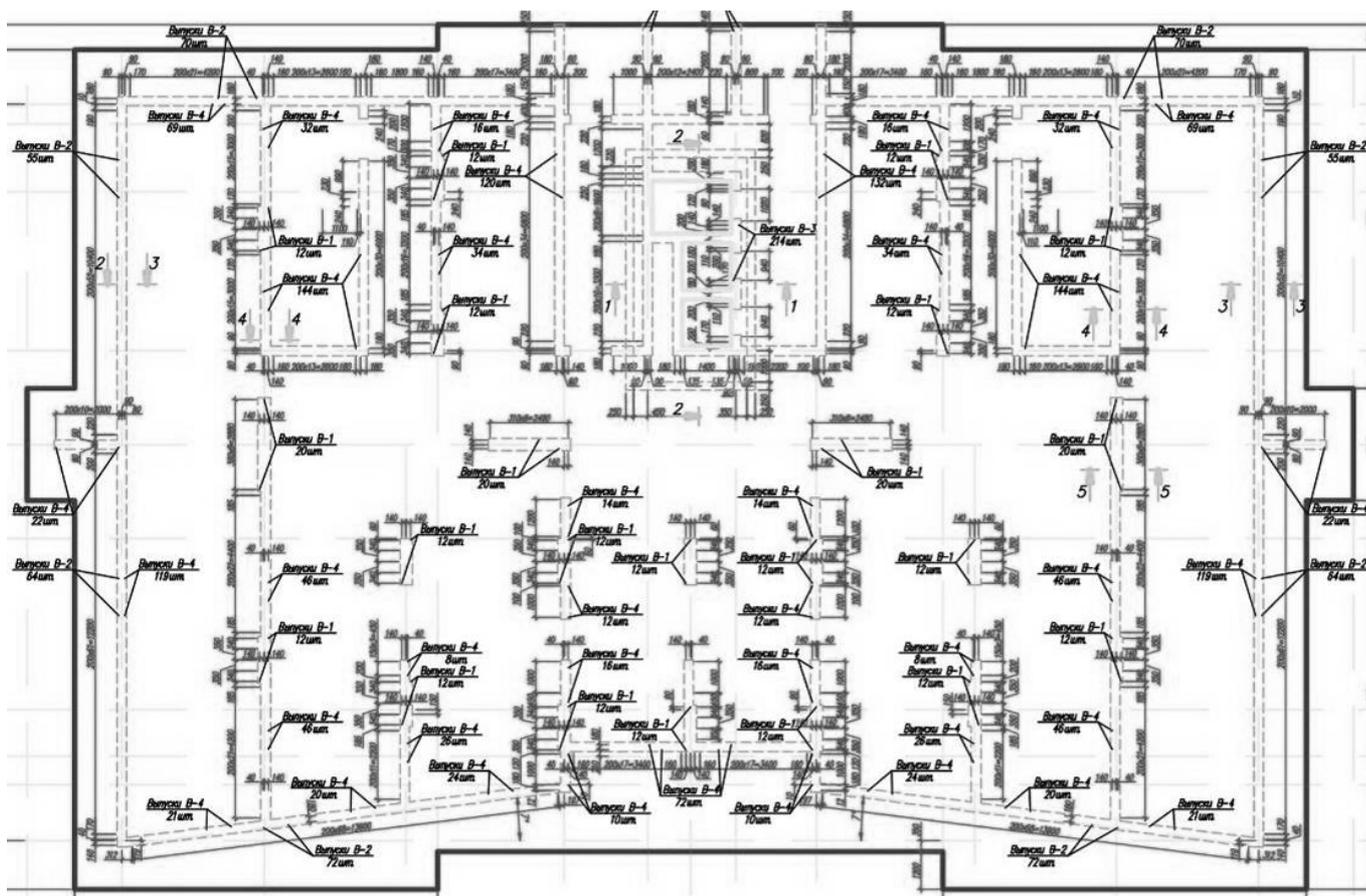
Опалубочный план плитного ростверка комбинированного свайно-плитного фундамента (КСПФ)
